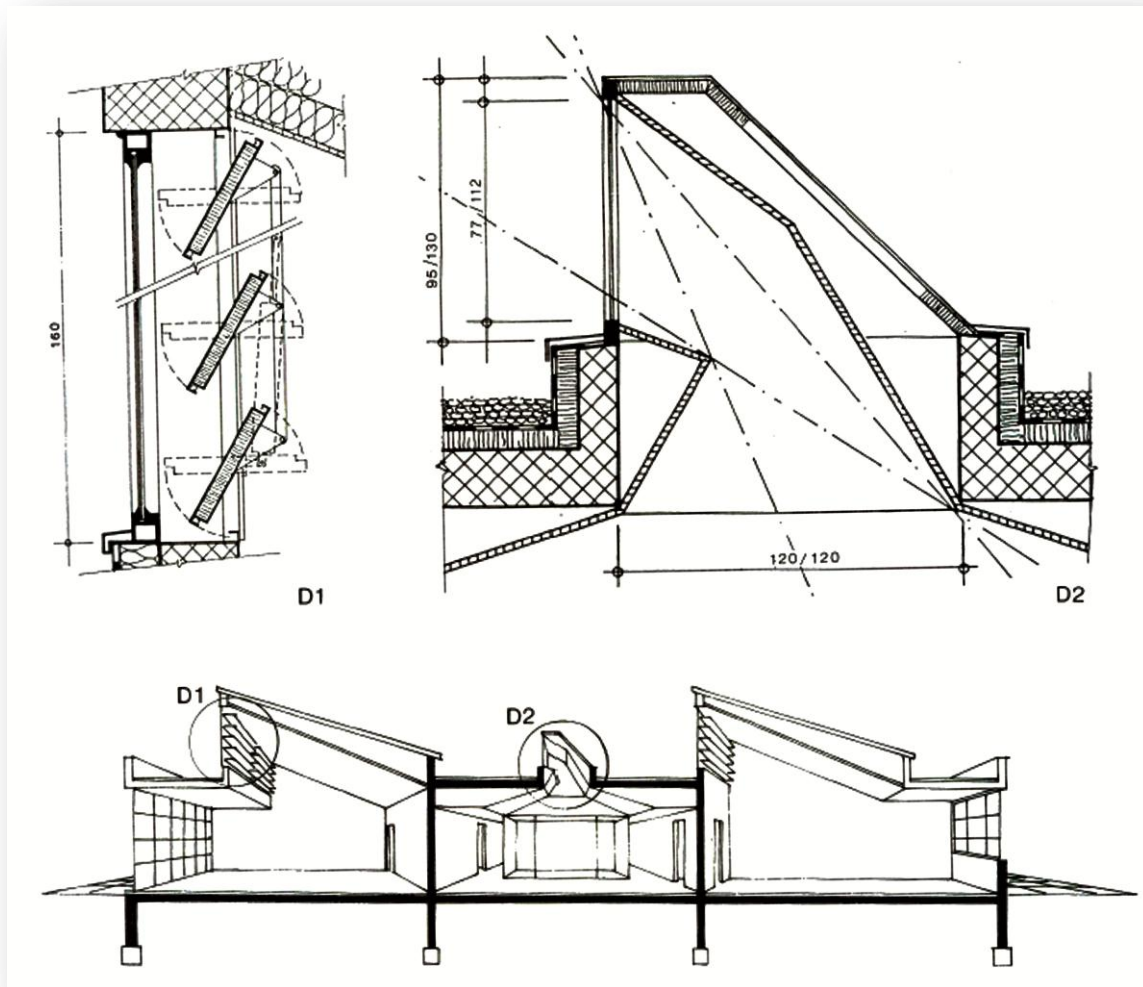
Detalle constructivo – Conducto Solar – Lúmenes.
